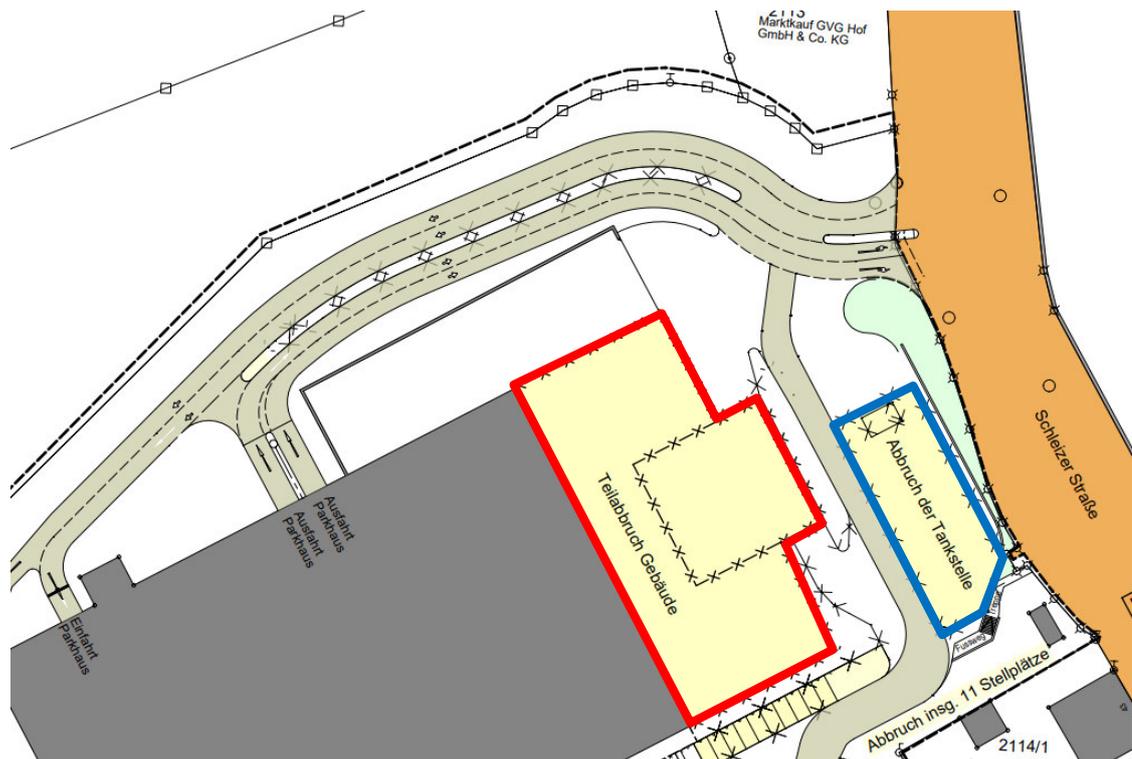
Auszug Lageplan Abbruch, Quelle: Architekturbüro Wittig, 2021
